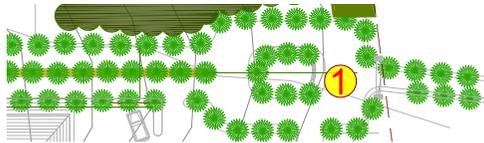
k. Site Plan Eco-Resort Cipelang, Zona K: Penyanga Batas Kawasan, Cipelang, Cijeruk, Bogorr
